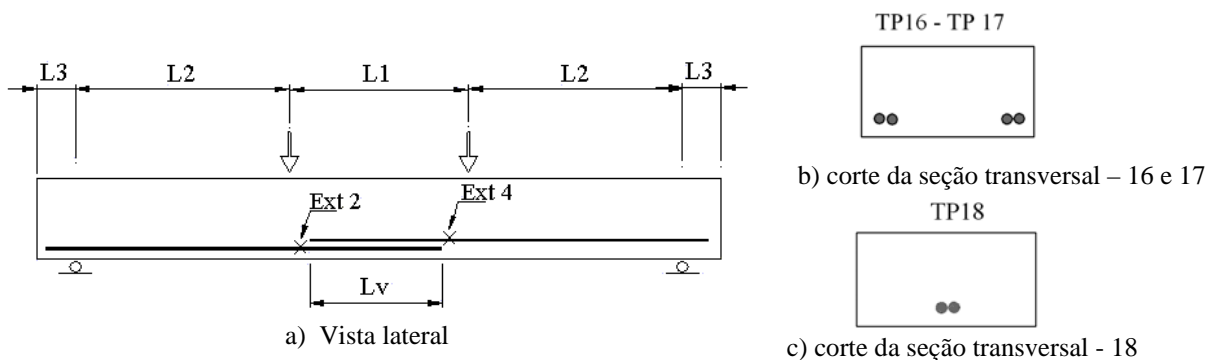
Disposição das barras nas vigas de transpasse (TP).
